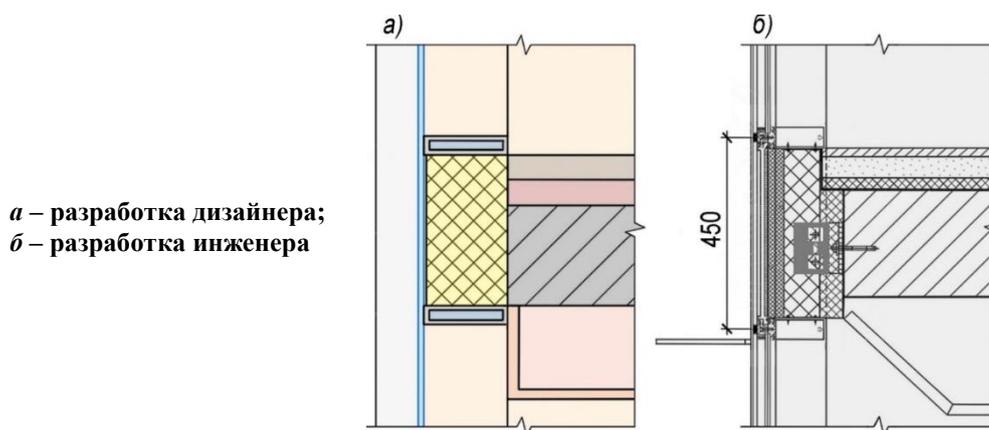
Узел примыкания витражного остекления к междуэтажному перекрытию общественного здания
